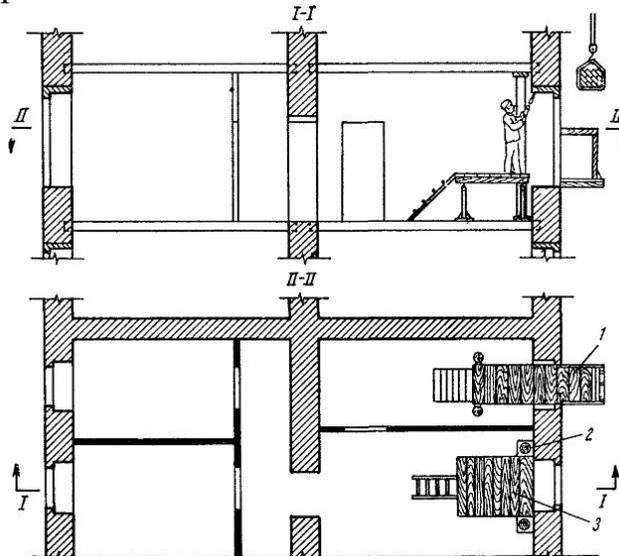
Технологическая схема работ по замене железобетонной оконной перемычки
